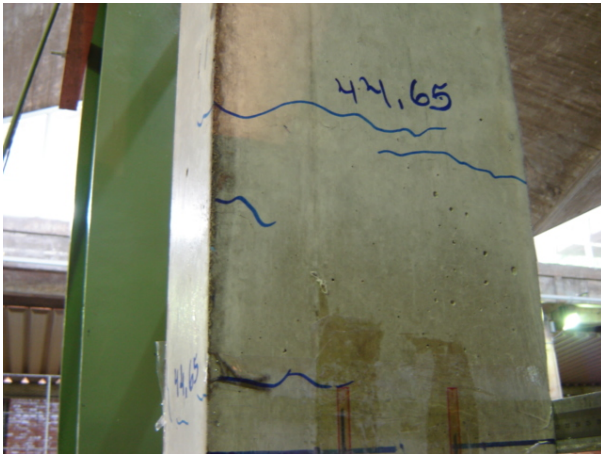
Fissuras do pilar PFN15-3
